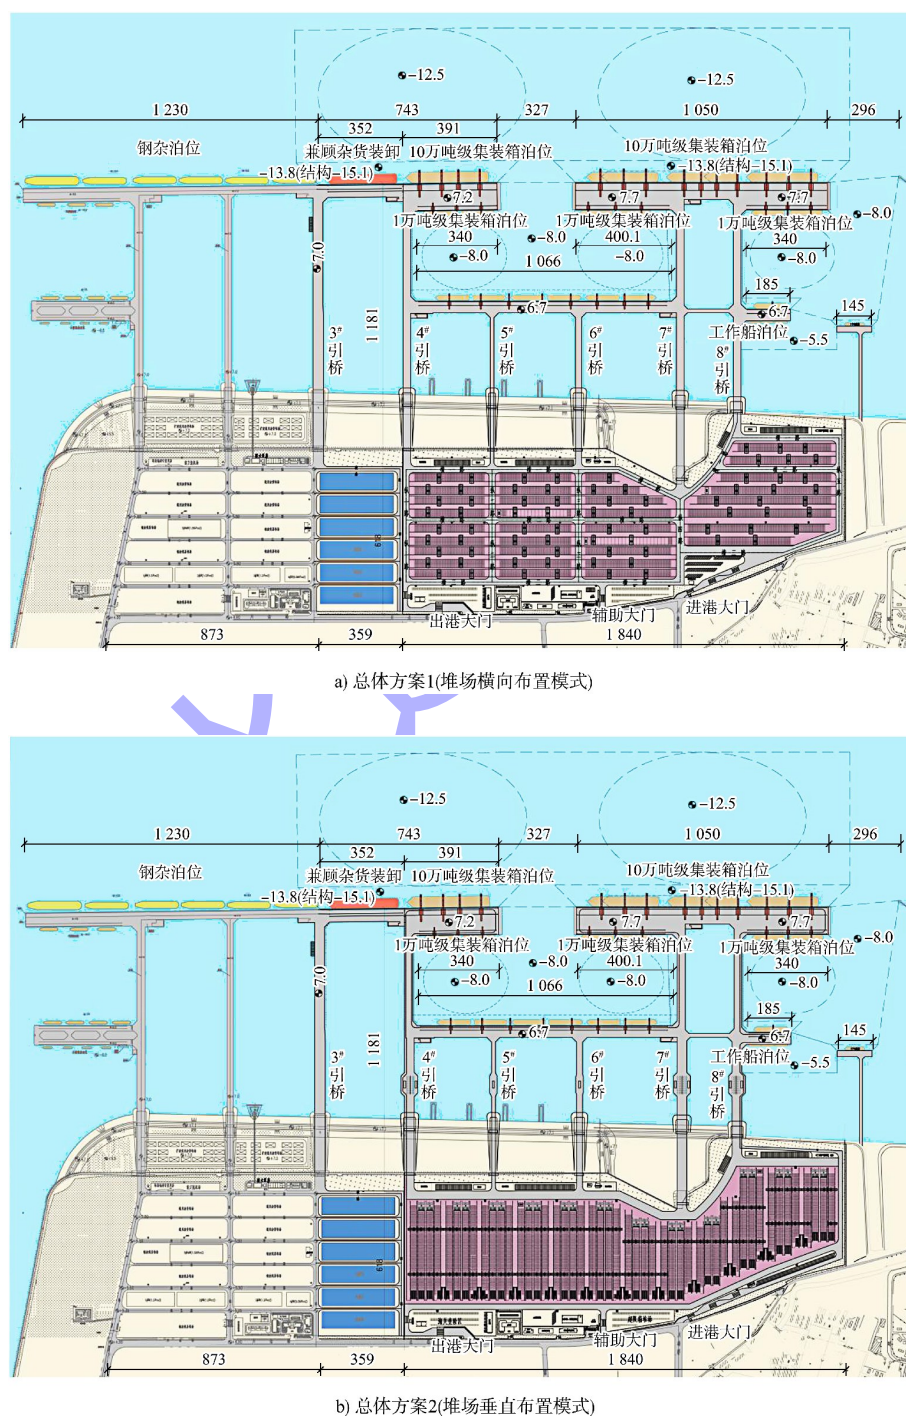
两种方案总平面布置 (高程: m; 尺寸: m)
